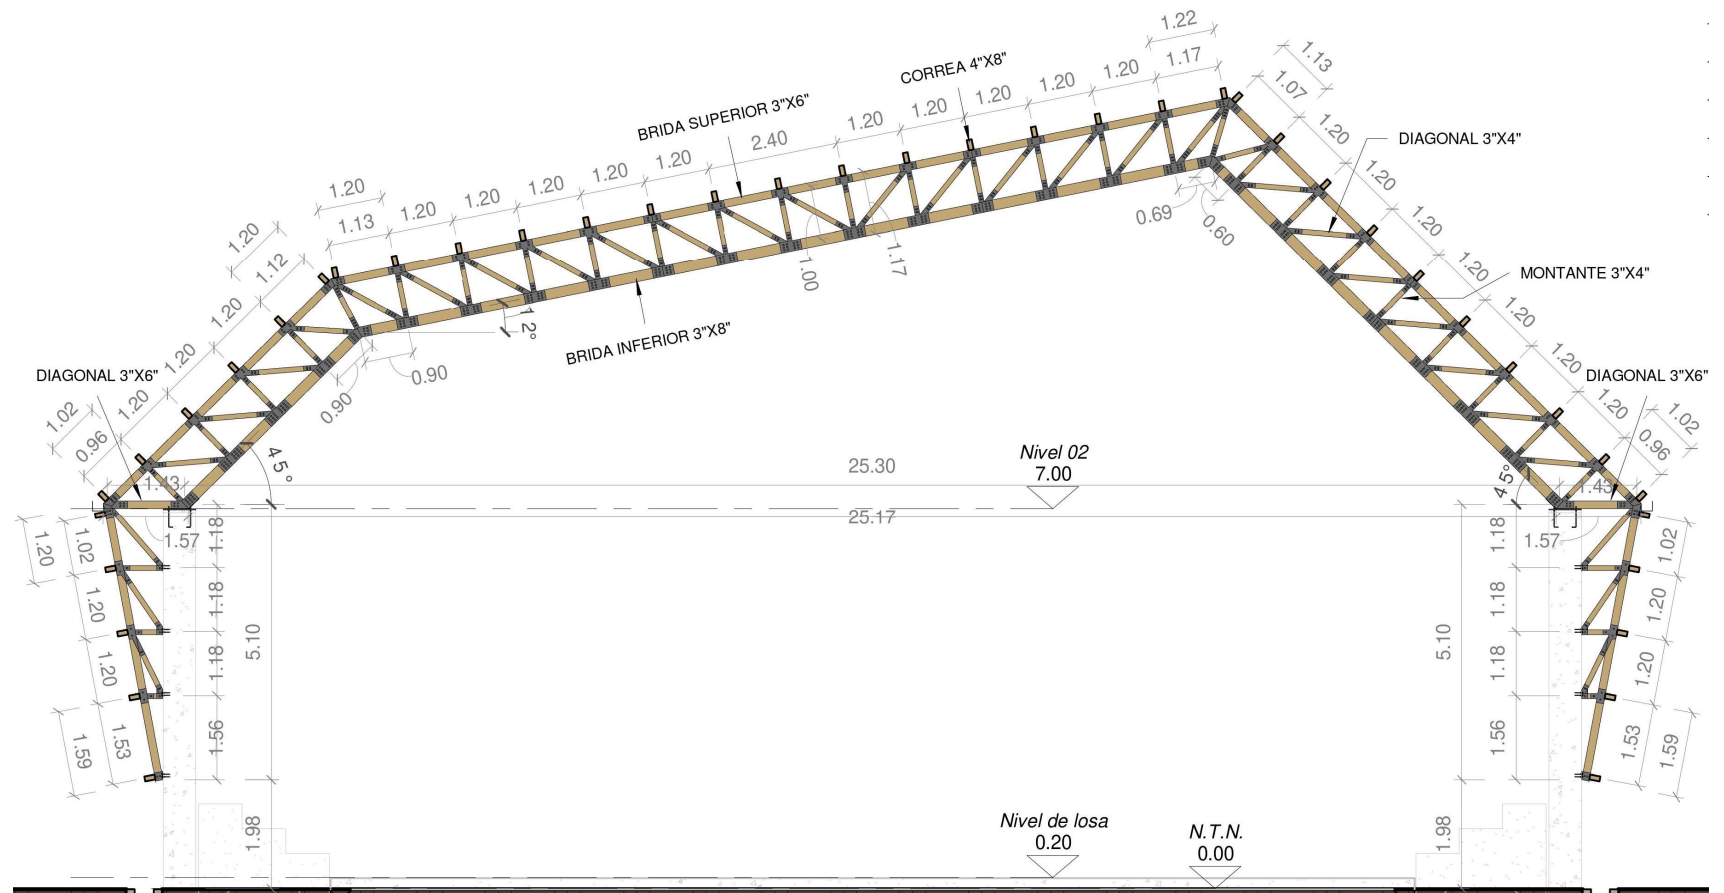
Cobertura de Madera, Detalle Arquitectónico
